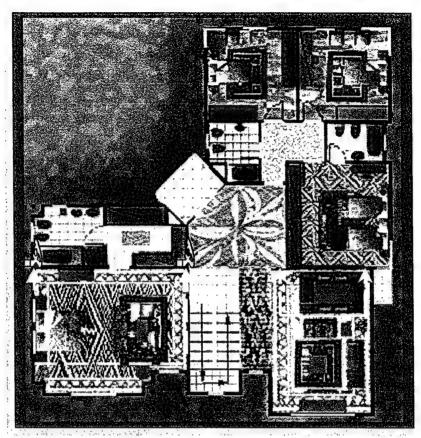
مسقط أفقي للدور الأول يوضح توزيع الأثاث عليه (نموذج رقم ١)
